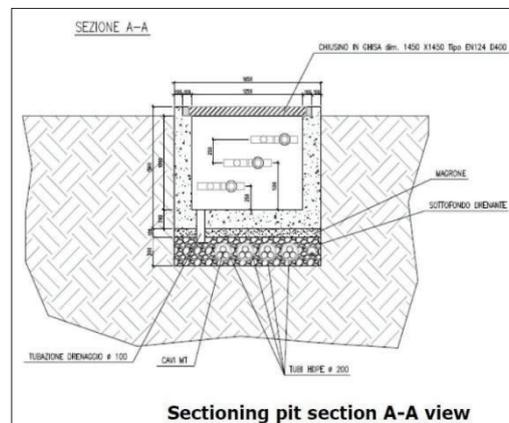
Vista in sezione dei giunti sconnettibili all'interno dei pozzettoni di sezionamento
